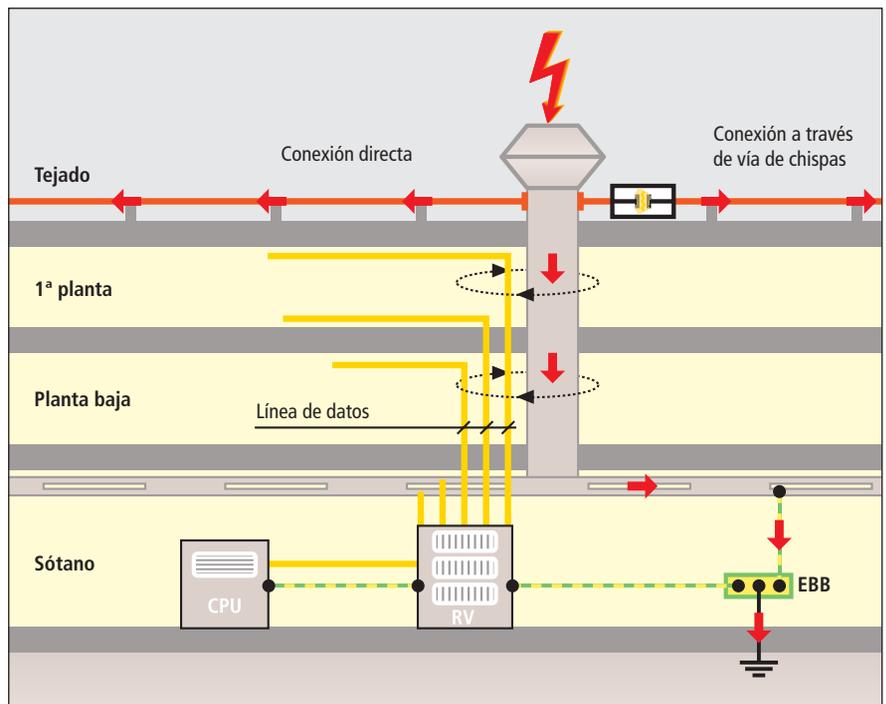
Conexión de estructuras sobre cubierta.
